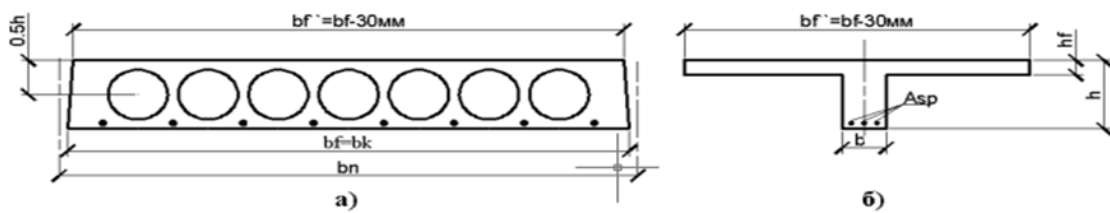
Поперечні перерізи багатопустотної плити:
